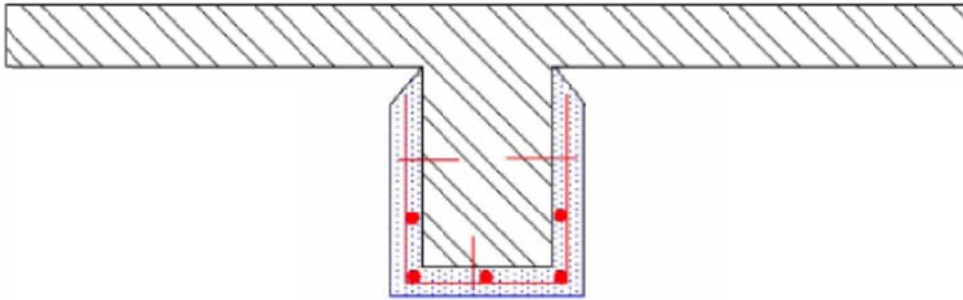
Renforcement d'une poutre par chemisage [6].
